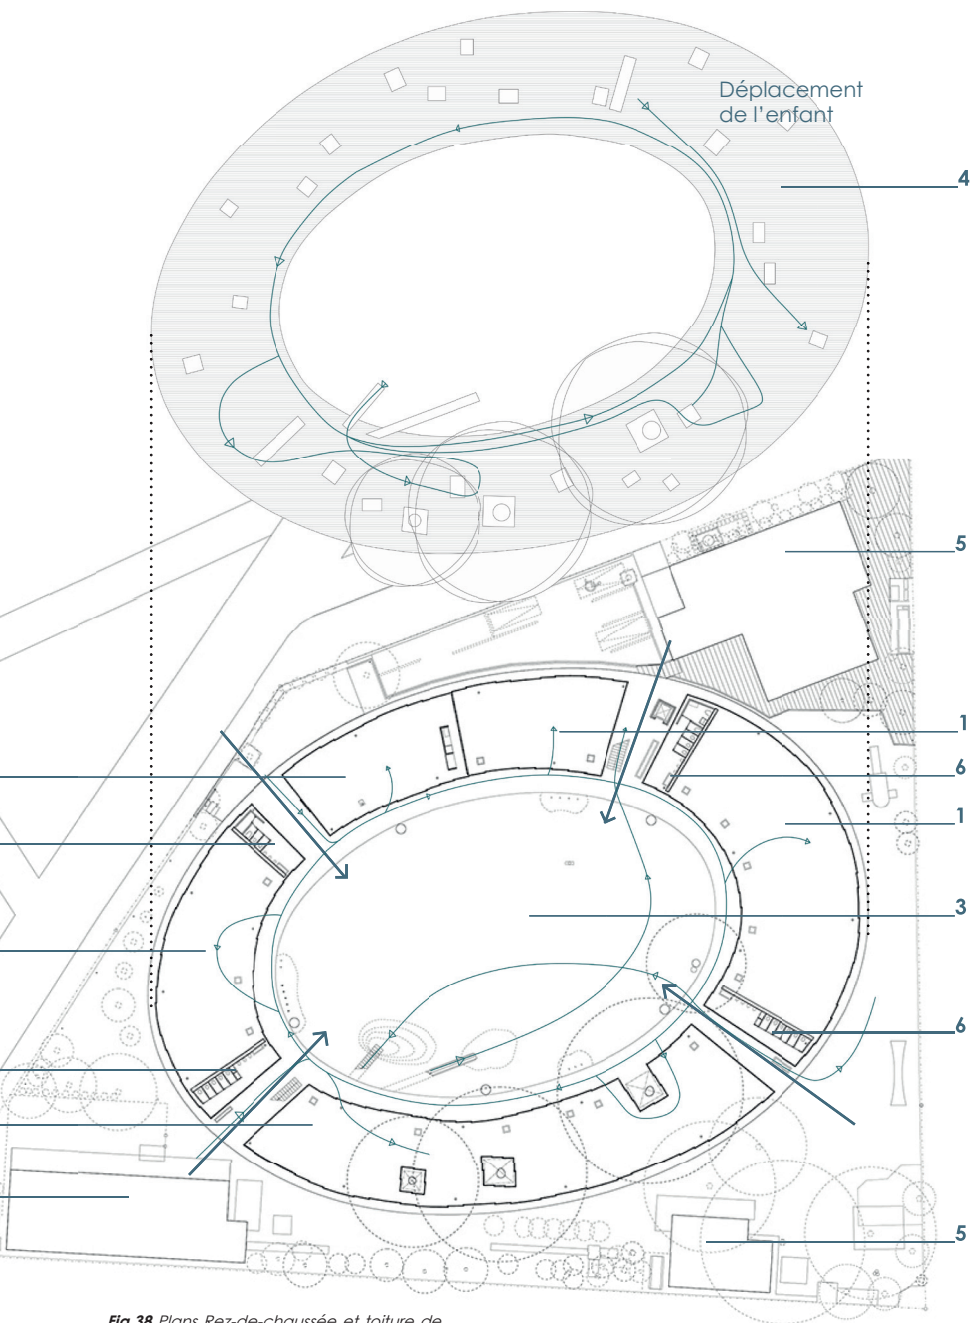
Plans Rez-de-chaussée et toiture de l'école Yamamotochou Fuji, Tachikawa
